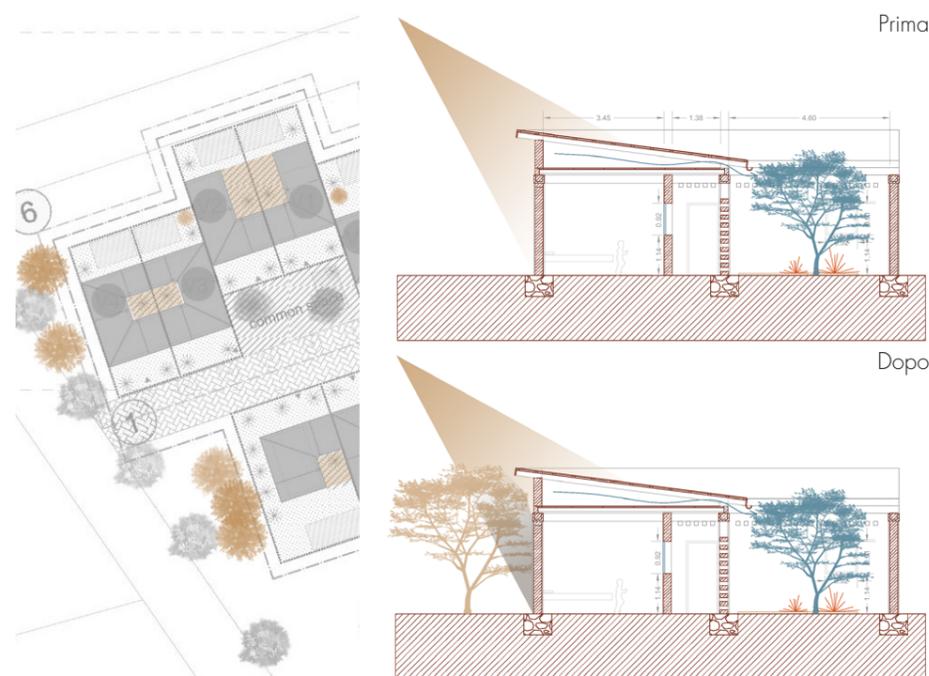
Planimetria e sezione unità abitative e nuova vegetazione (Fonte: elaborazione propria).
